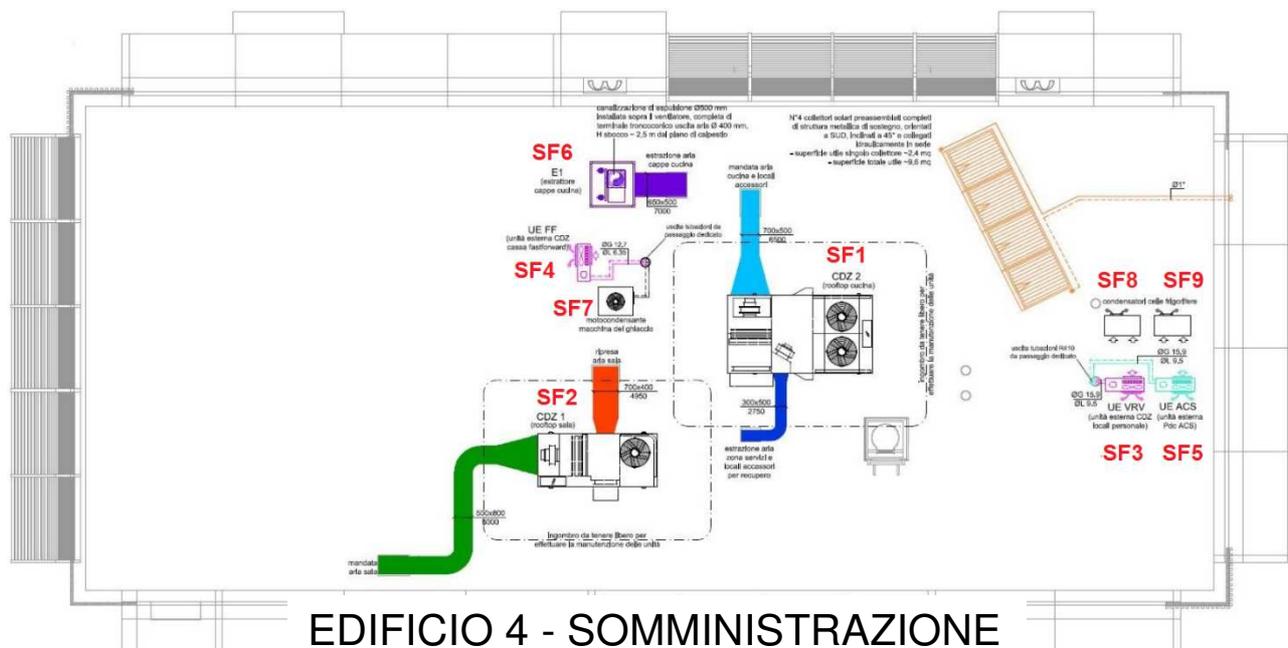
Dettaglio posizionamento delle sorgenti di rumore previste dal progetto - Pianta copertura.
